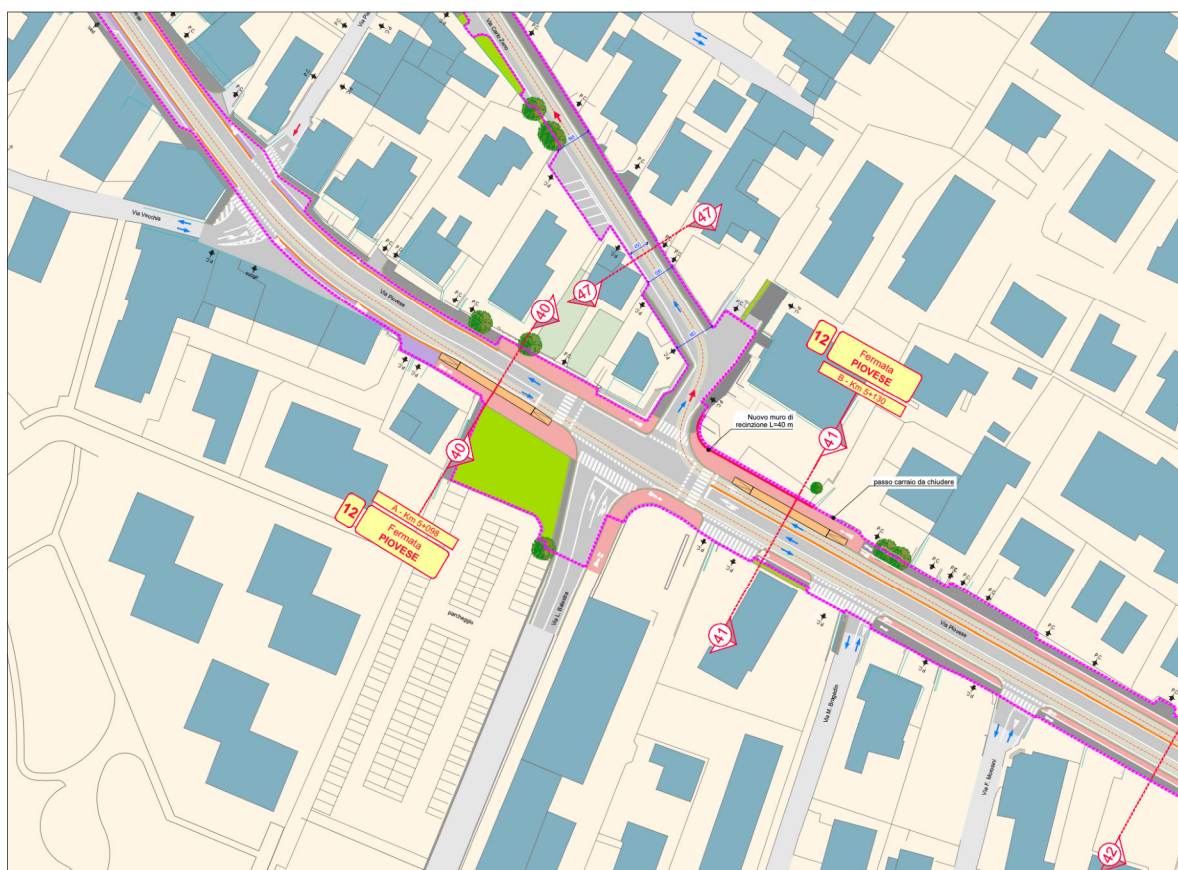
Progettazione definitiva della nuova linea tramviaria SIR3, inserimento urbano. Planimetria Tratta via Piovese - via Zeno (dal km 4+960 al km 5+340). Dettaglio relativo alla sistemazione del tratto corrispondente alla fermata “Piovese”, poco prima del capolinea sudest.
